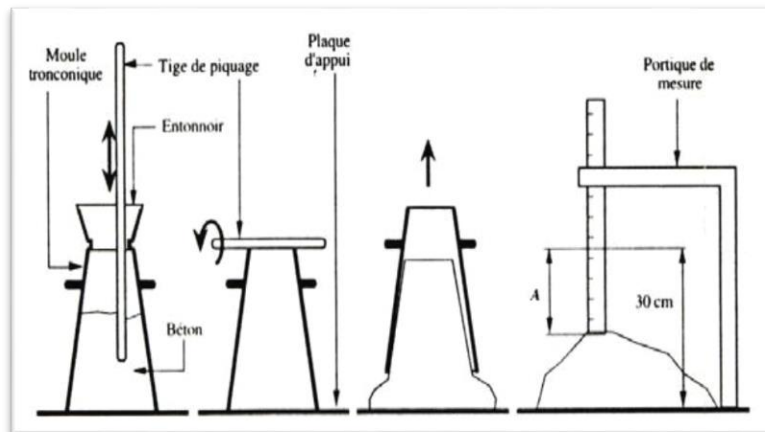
Essai d'affaissement ou cône d'Abrams ou Slump-test : (NF P18-439)
